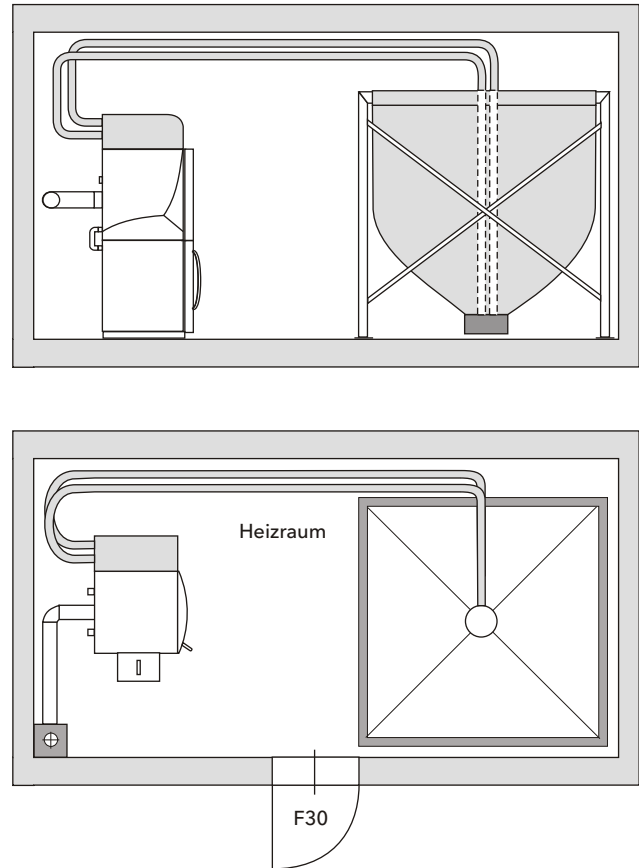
Kessel mit Saugsystem und Gewebesilo Schnitt (oben) und Aufsicht (unten)
